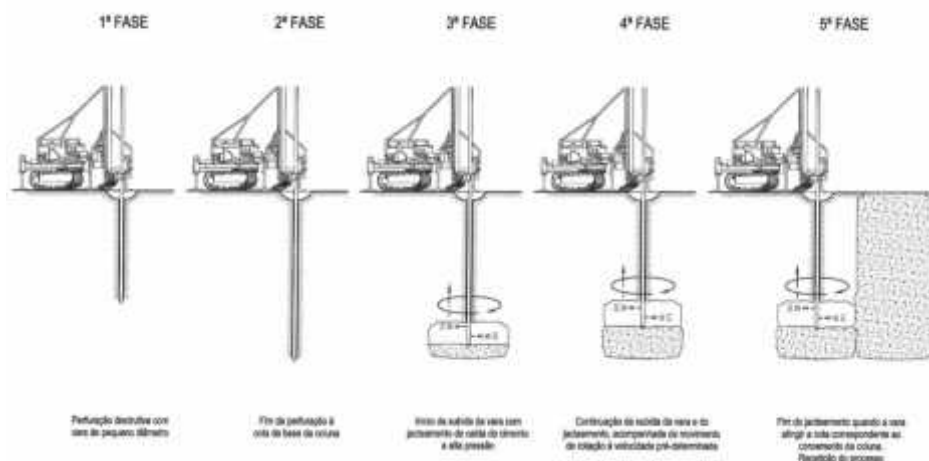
Representação esquemática da sequência construtiva de corpos de *jet grouting* simples [arquivo de imagens e fotos da empresa jetsigeotecniica,lda].
